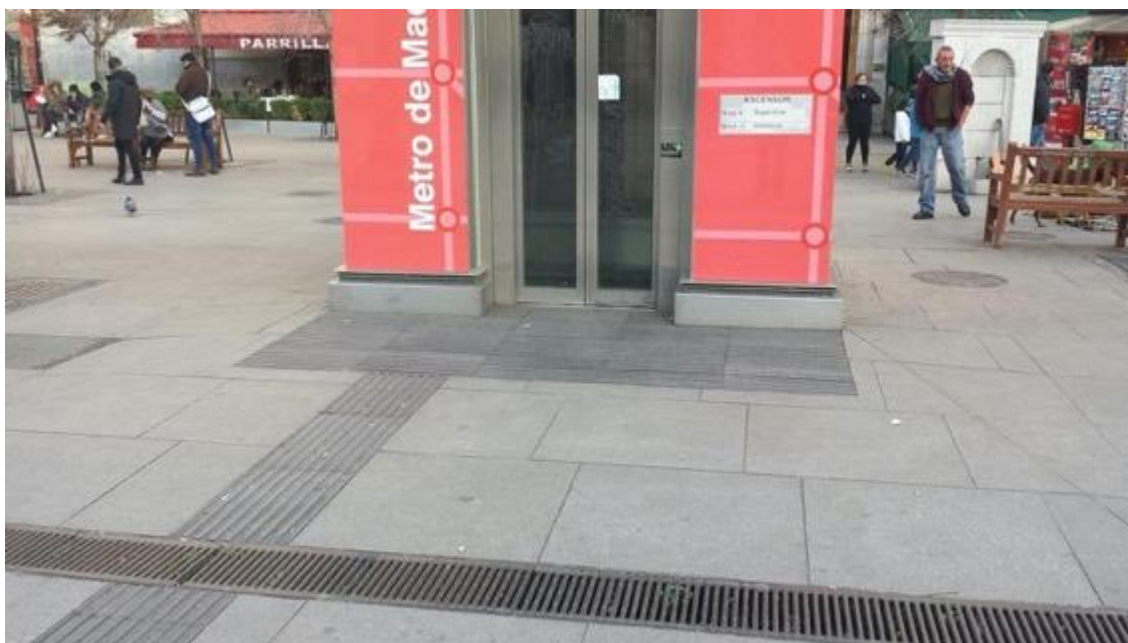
Ascensor de acceso a Metro en la Plaza de Isabel II. Ejemplo de disposición del pavimento en entorno urbano, empleando una banda de acanaladura de ancho 40 cm para generar un encaminamiento hasta el ascensor, que dispone a su vez de un pavimento tacto-visual en todo su ancho con fondo 120 cm
